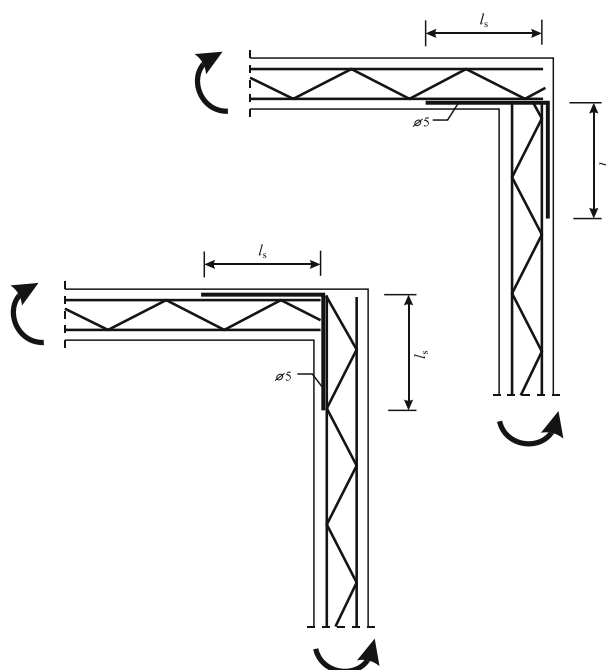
Горизонтальное армирование сетками Murfor угловых зон каменных зданий при действии отрицательного изгибающего момента [34,35,36]
